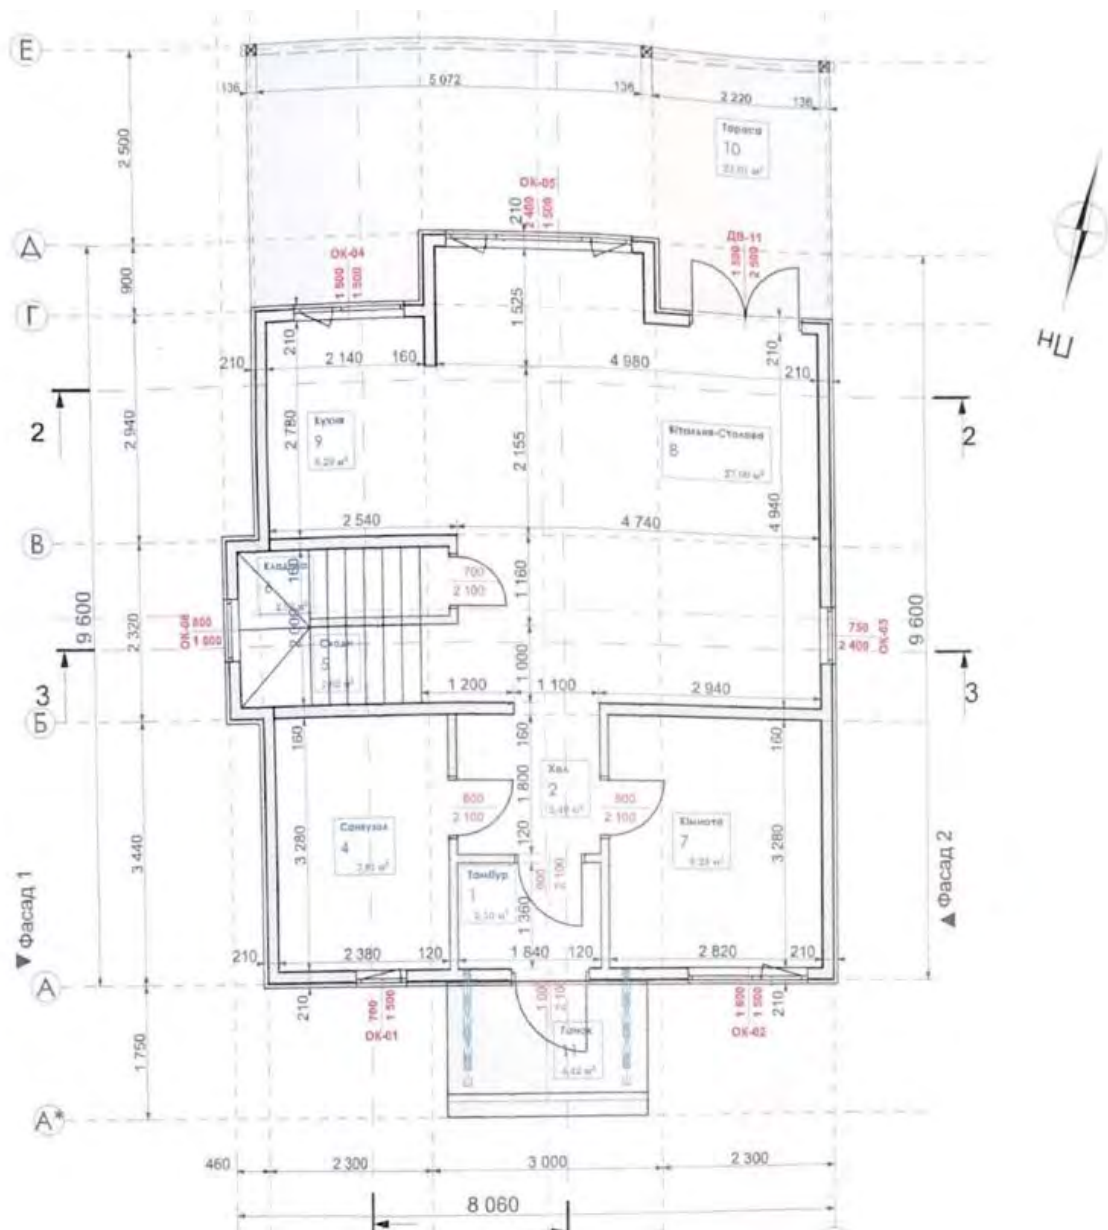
Кресленик першого поверху котеджу, реалізований в додатку SketchUp Layout
